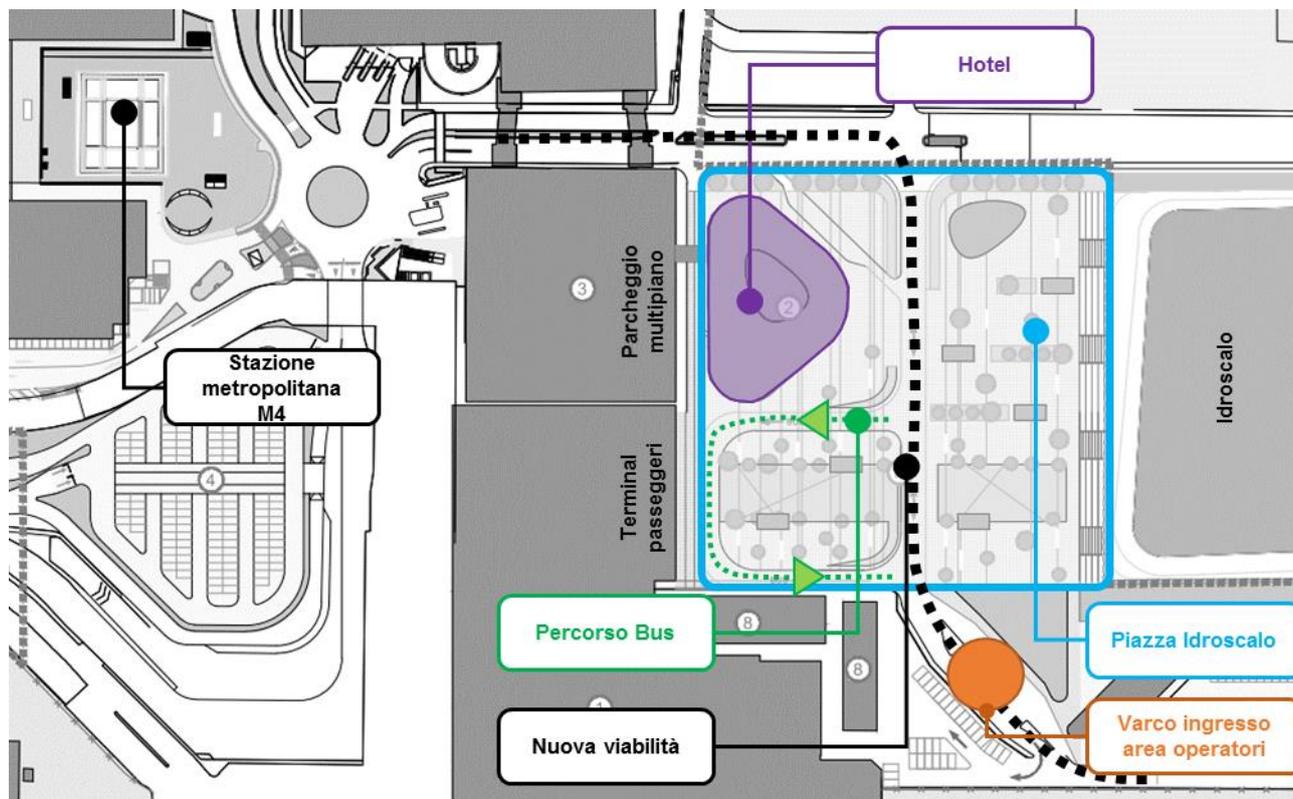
Strutture landside est: hotel e piazza idroscalo, configurazione prevista dal Masterplan (Fonte: Masterplan, Schede Interventi – Scheda 2.1)
